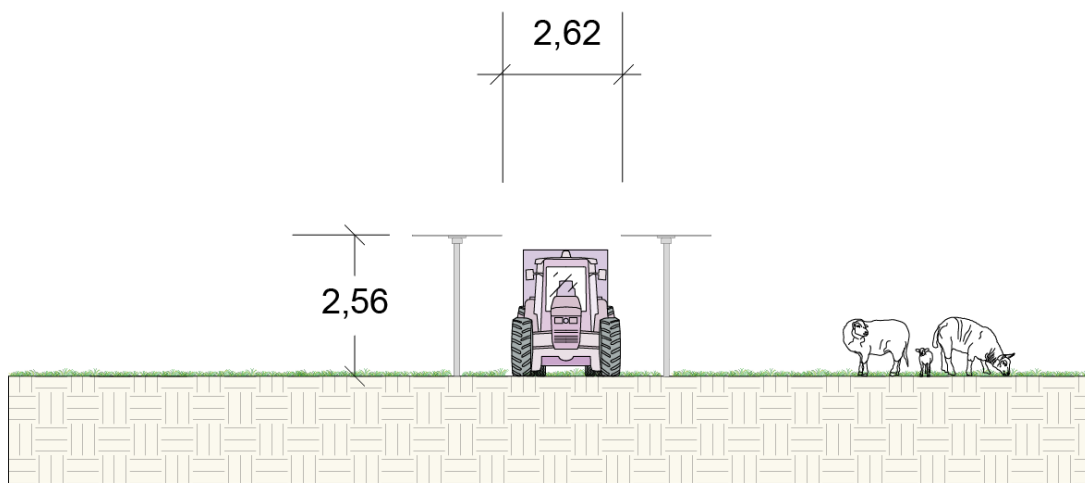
SISTEMA AGRIVOLTAICO ELEVATO, SEZIONE TIPOLOGICA DELL'IMPIANTO
